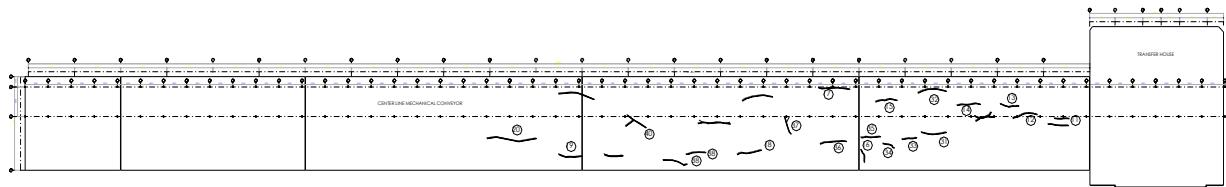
Selimut beton pancang baja mengalami keretakan
